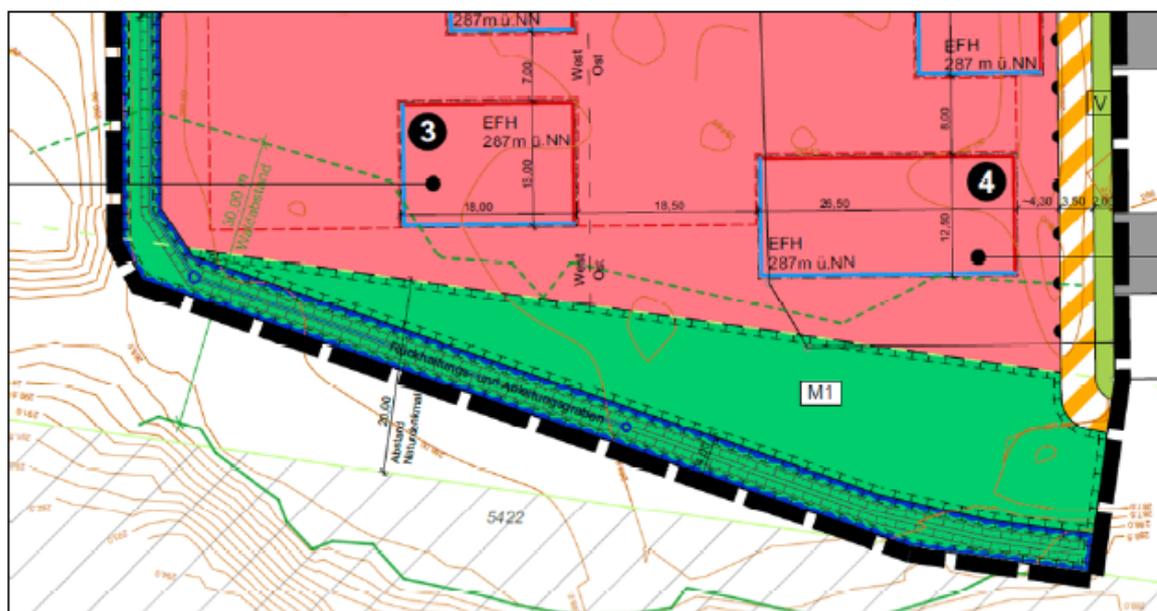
Ausschnitt Entwurf Planzeichnung vom 26.07.2022, Bebauungsplan „Alte Ziegelei“ Nürtingen
